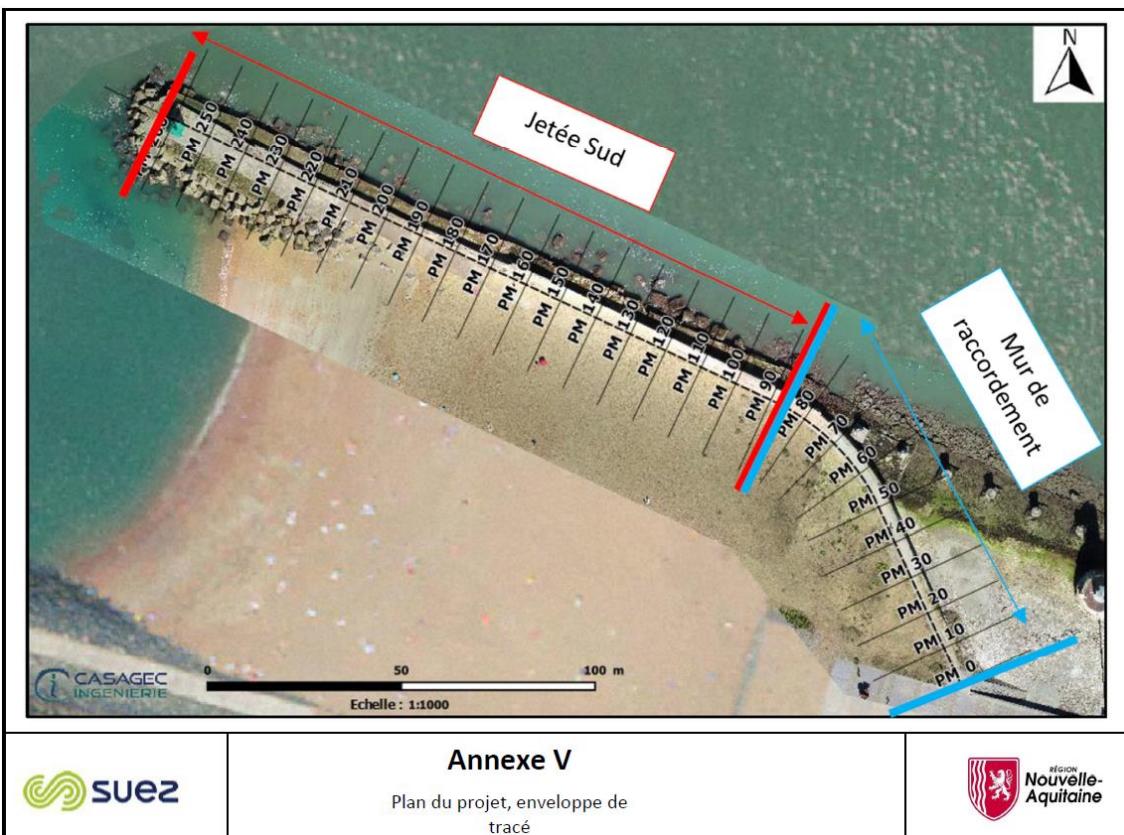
Plan du projet et enveloppe de tracé – Source : SUEZ Consulting, CASAGEC INGENIERIE
